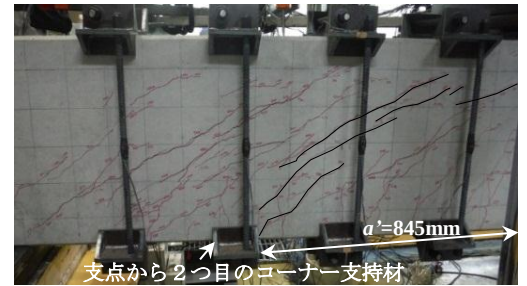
No. 2 の最大荷重時のひび割れ発生状況
